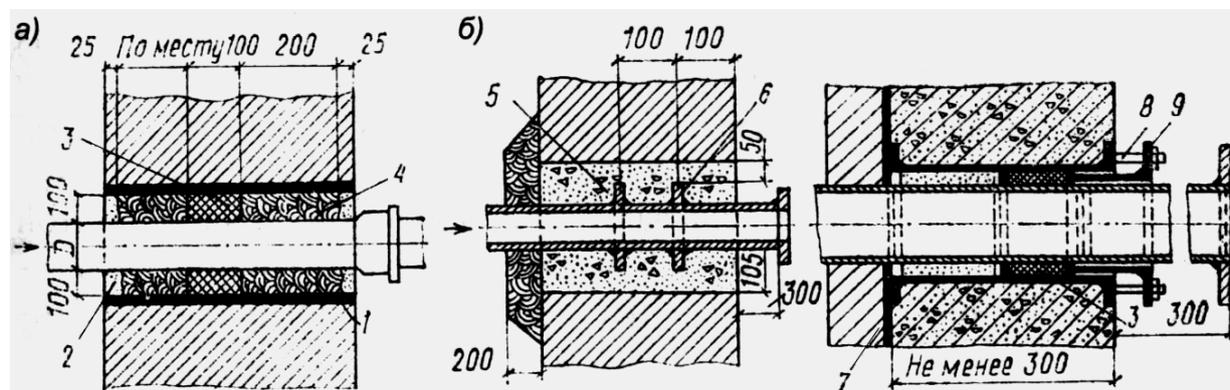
Заделка трубы ввода в фундаменте здания в сухих (а) и водонасыщенных грунтах (б): 1 – гильза; 2 – цементный раствор; 3 – смоляная прядь; 4 – глина; 5 – бетон; 6 – фланцы; 7 – гидроизоляция; 8 – стяжные болты; 9 – грундбукса
